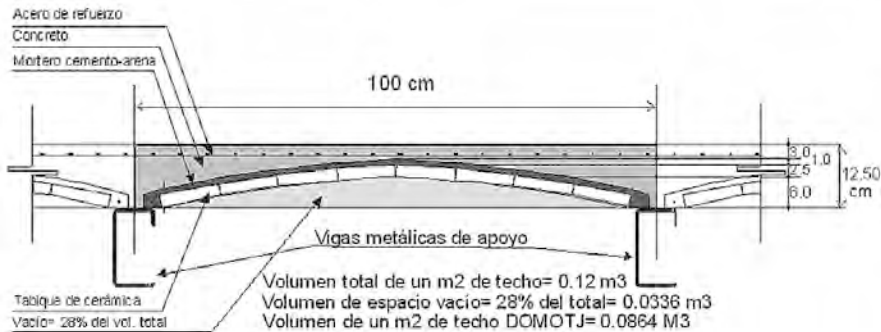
Corte de un metro cuadrado de techo Domotej con el cálculo de volumen de concreto utilizado.
